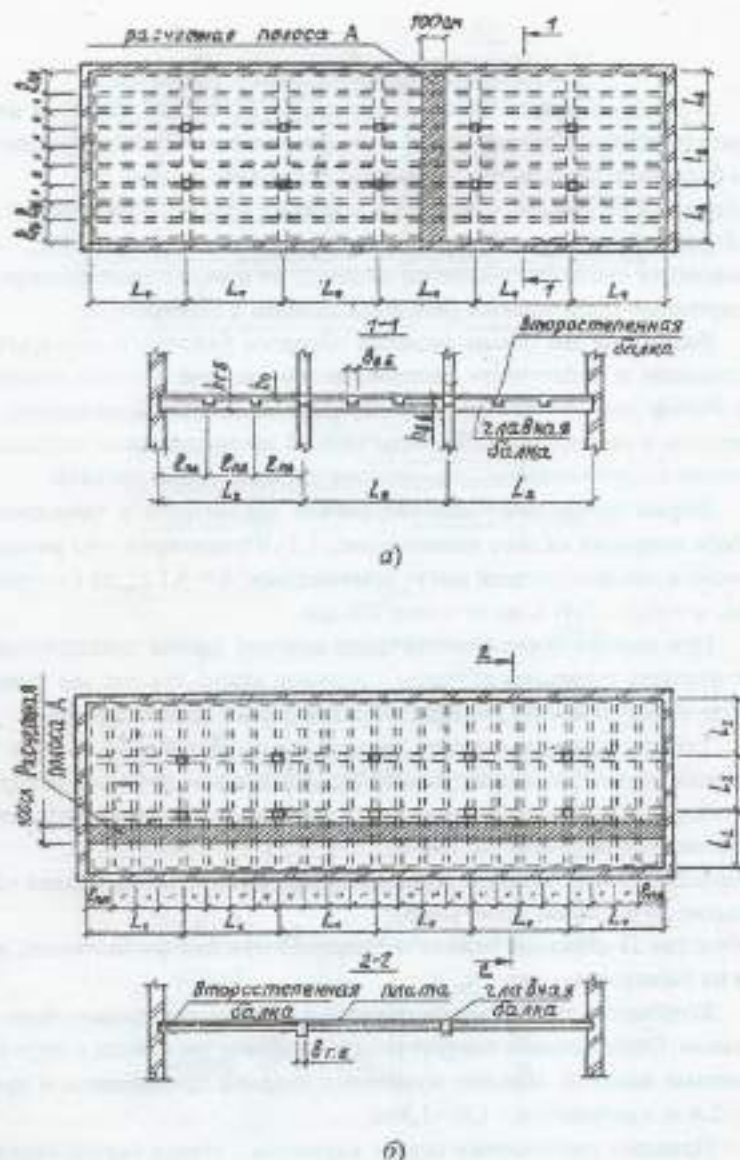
Варианты компоновки монолитного перекрытия:
